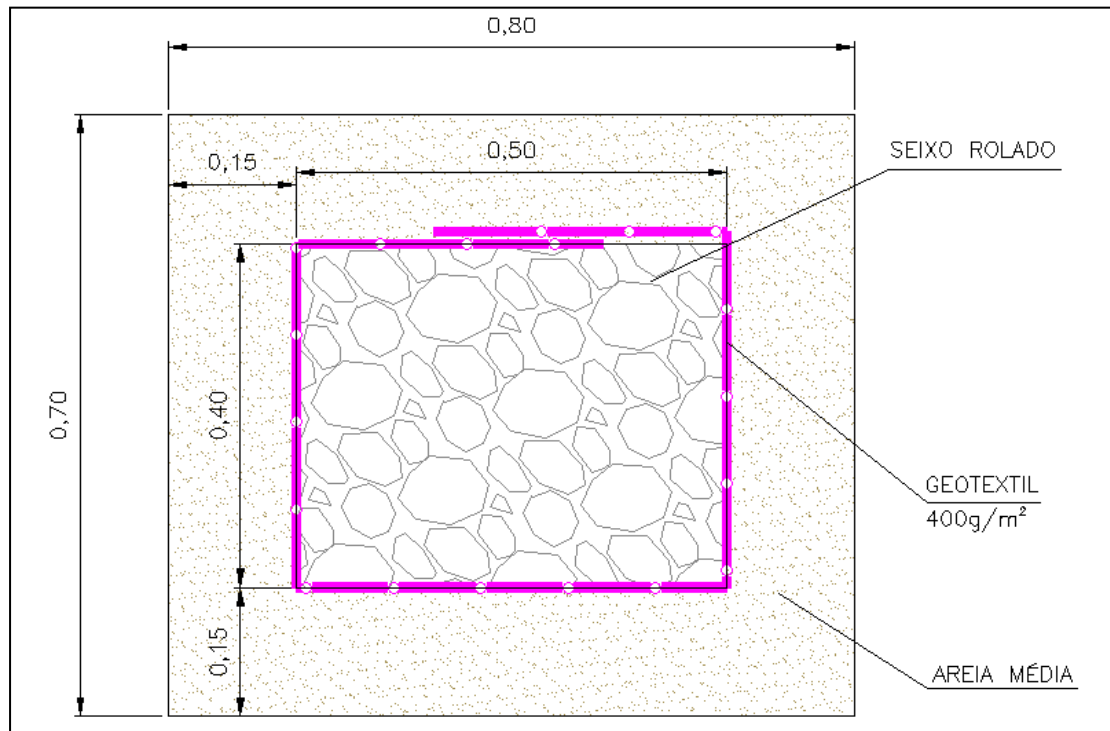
Detalhe Típico – Drenos (D1-3541-54-G-163)
